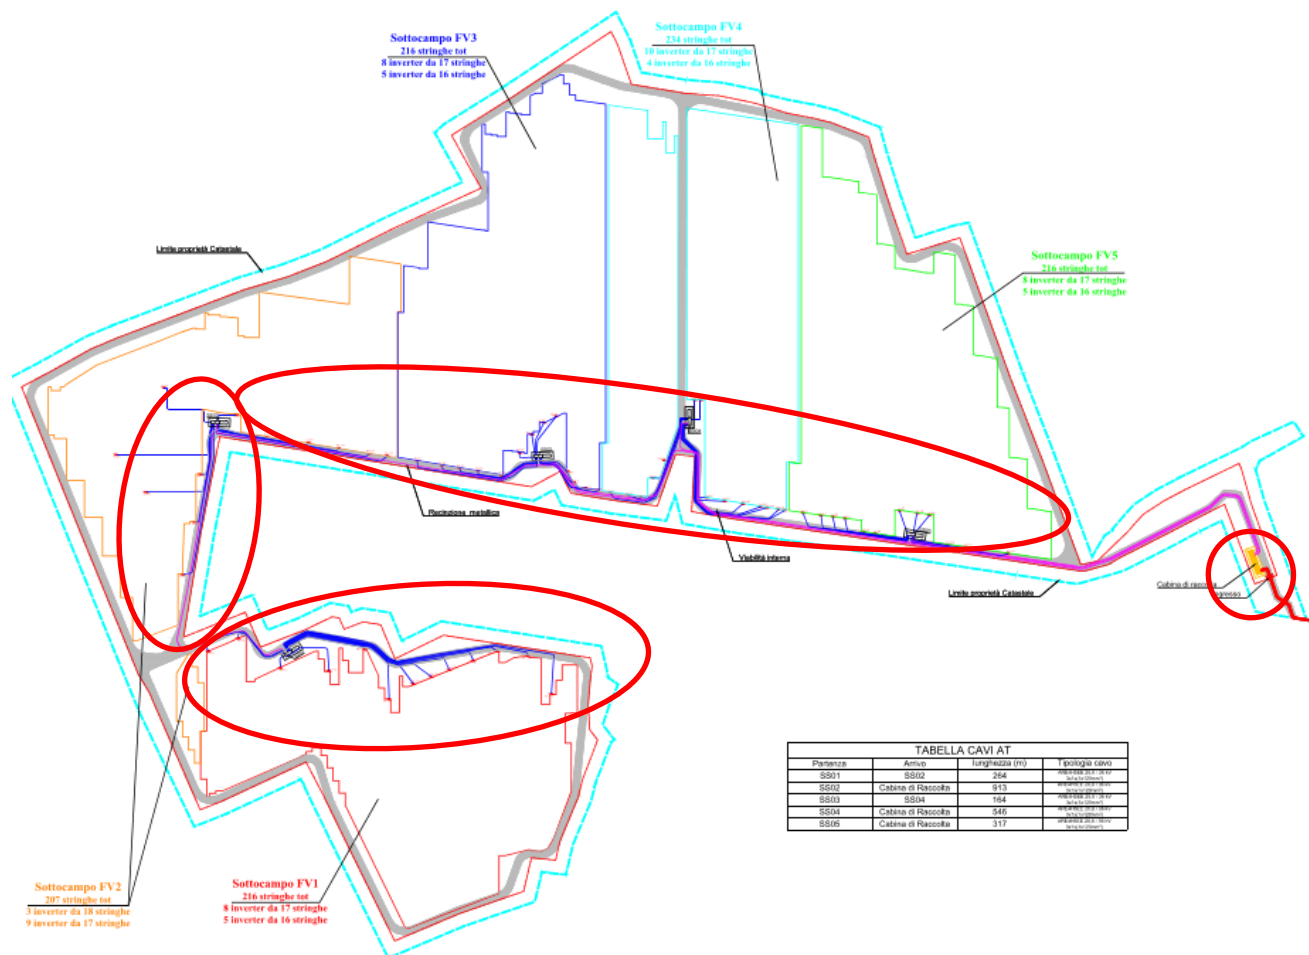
Planimetria ubicazione Lotto 1 con ubicazione sorgenti
